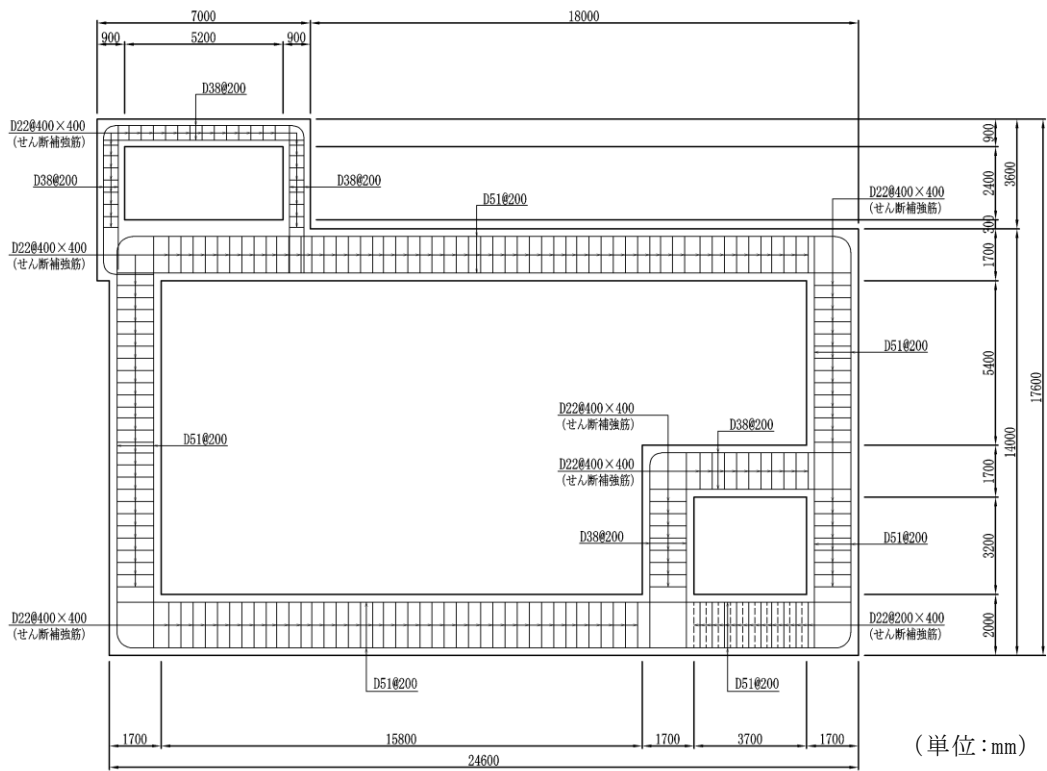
第 1 ベントフィルタ格納槽 概略配筋図 (C-C 断面)
